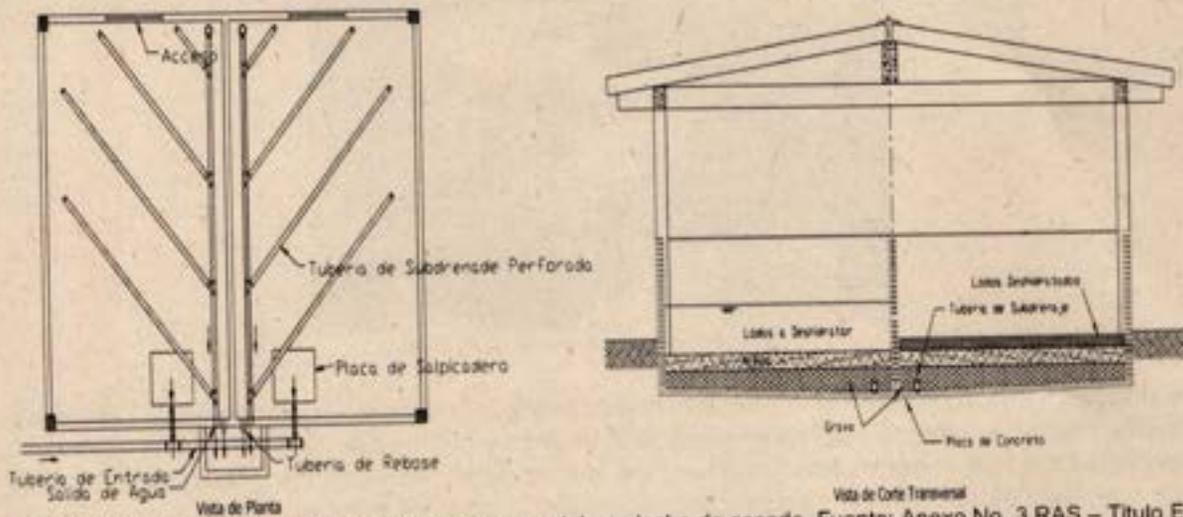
y 4: Vista de planta y de corte transversal de un lecho de secado. Fuente: Anexo No. 3 RAS – Título E
